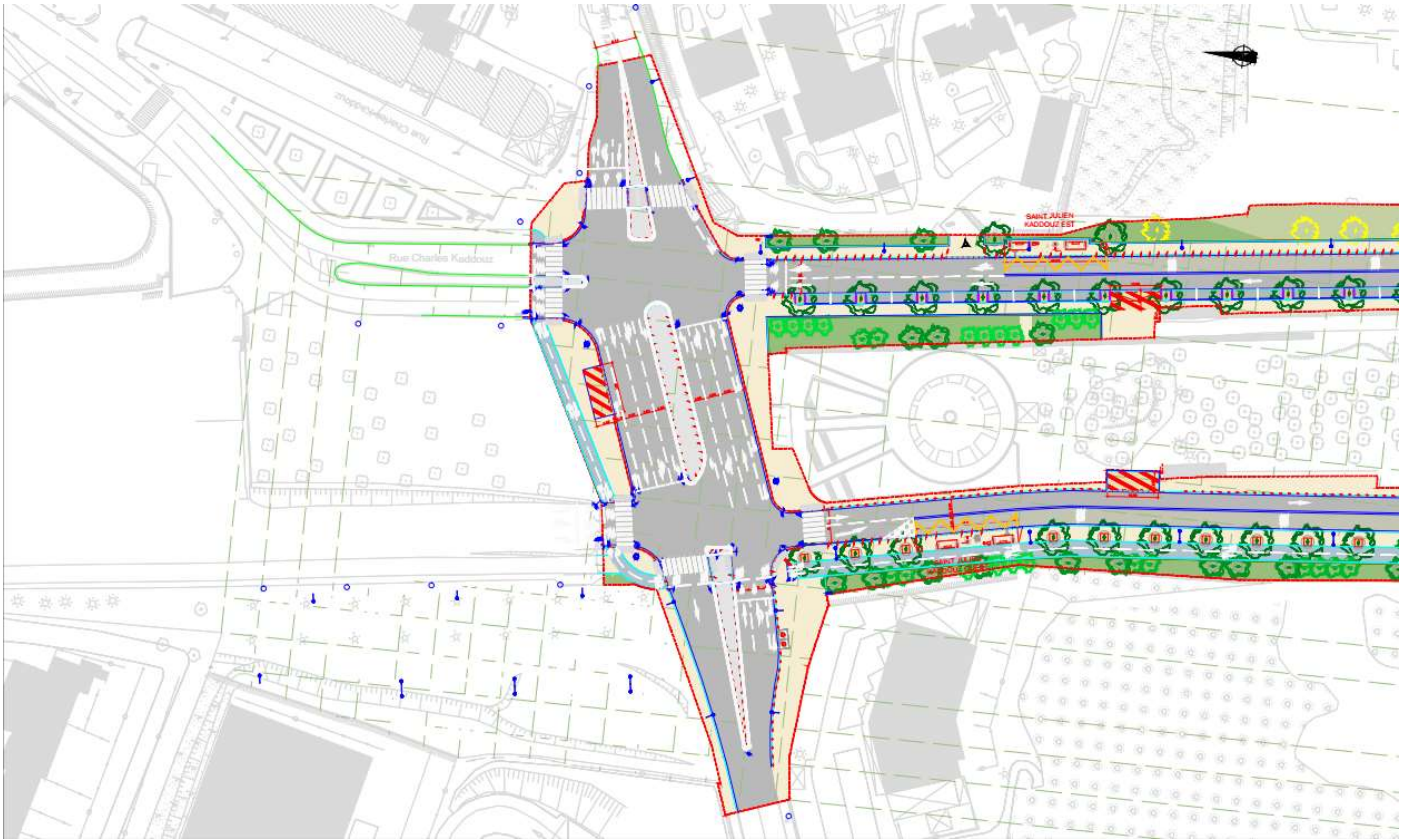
Plan de masse secteur St Julien - La Fourragère 1/3
